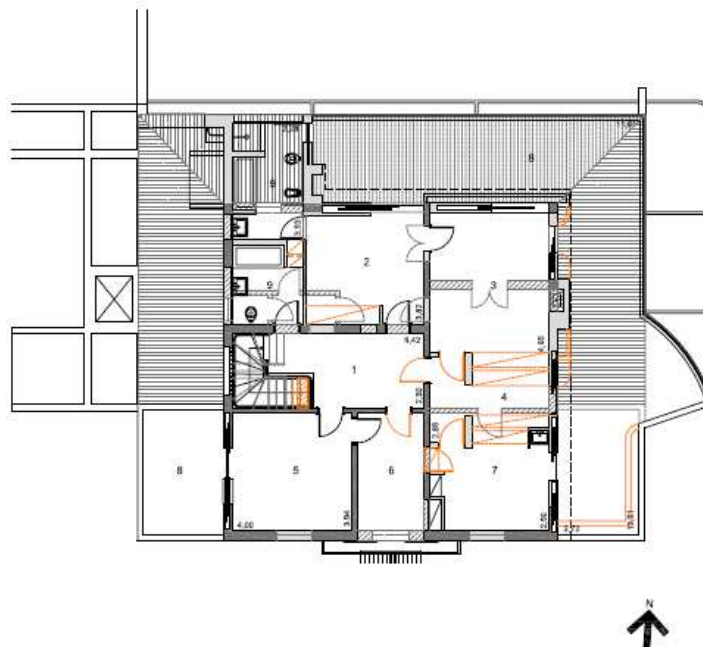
Planta pavimento superior. Em cinza escuro: remanescentes de 1928; Hachurado: demolido em 1935; Cinza claro: construído em 1935; Laranja: alterado em 2006. (Desenhado pela autora)
